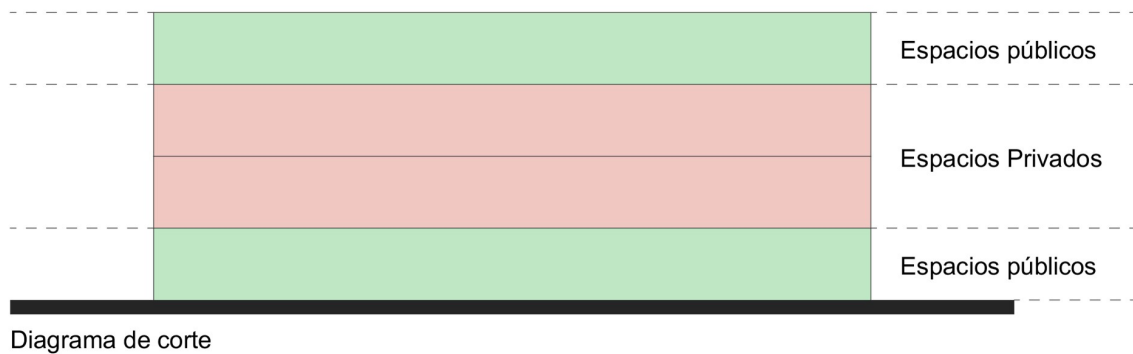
Privacidad por plantas. Fuente y elaboración: Autores
